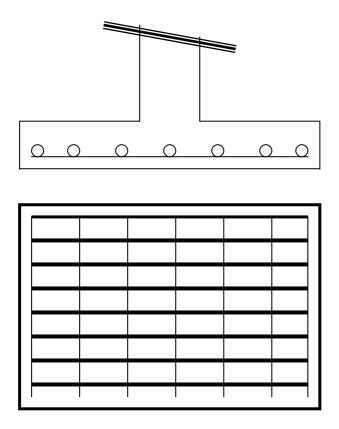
Refuerzo de cimentación continua de muro del ejemplo 12.1
